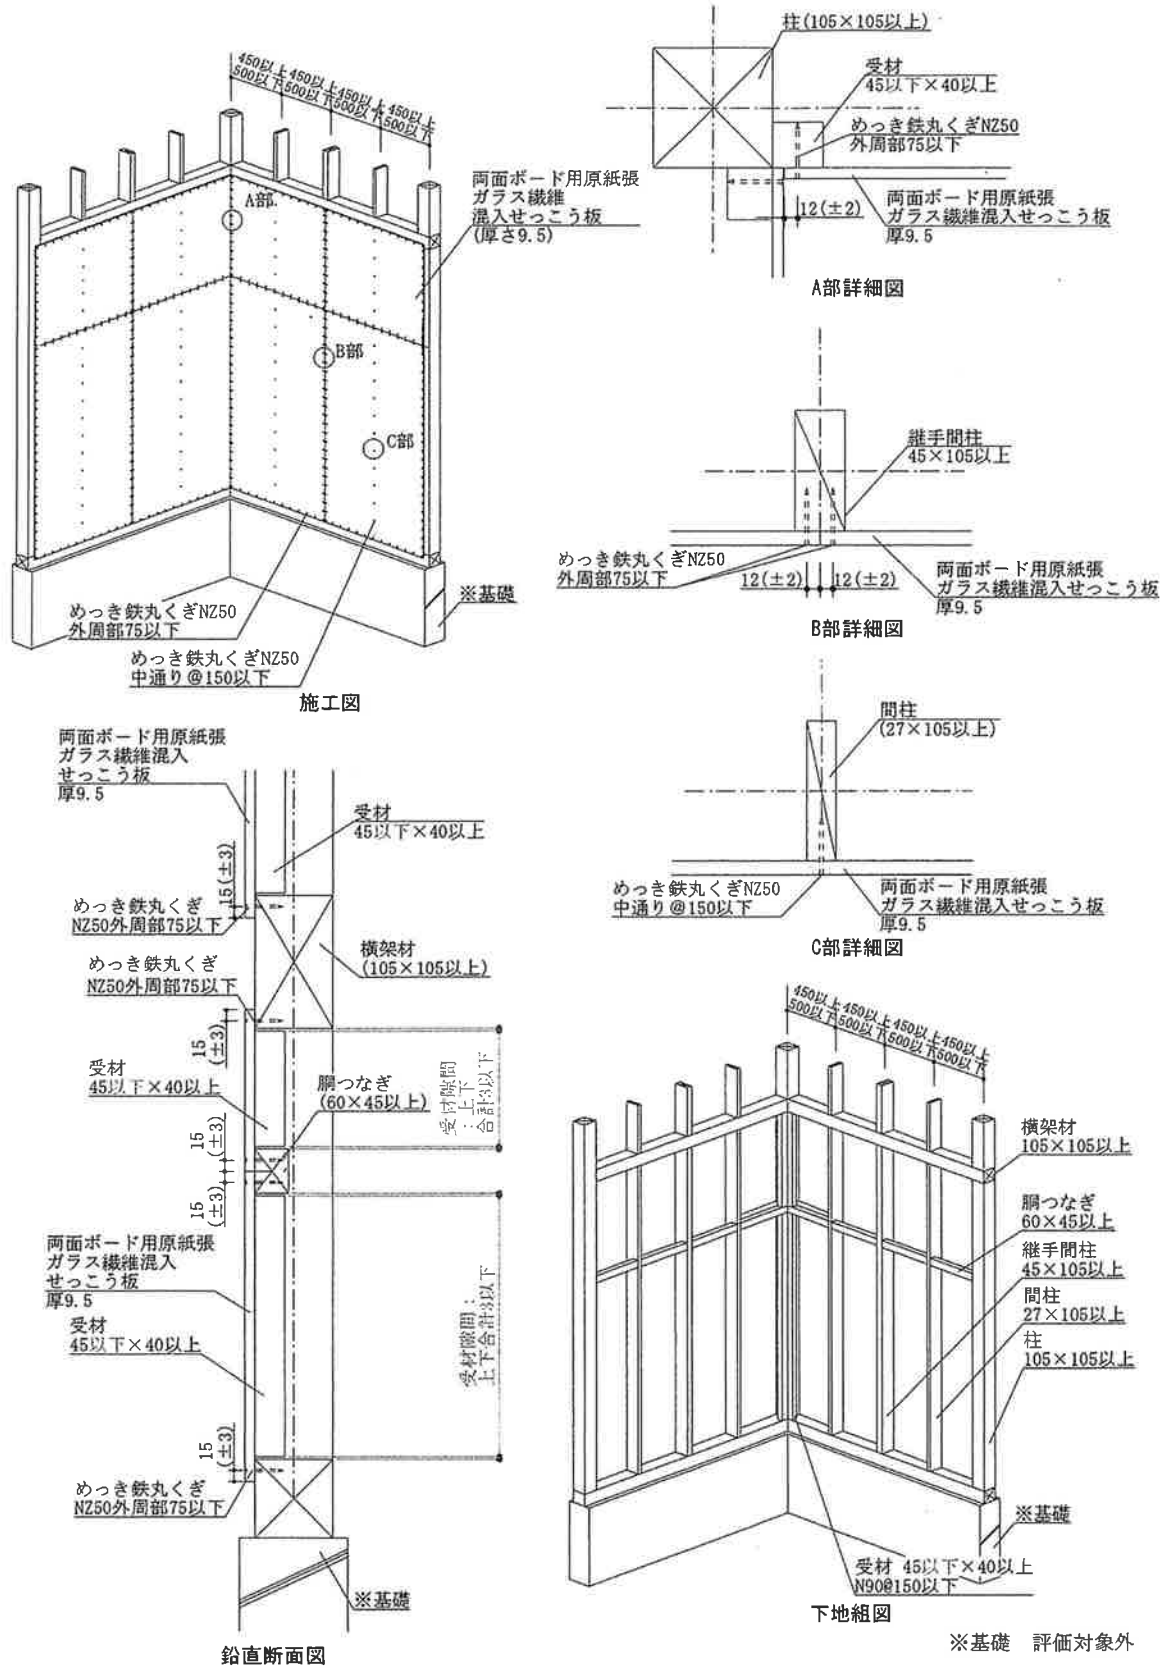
施工詳細図：縦継ぎ張りの場合 (寸法単位：mm)
